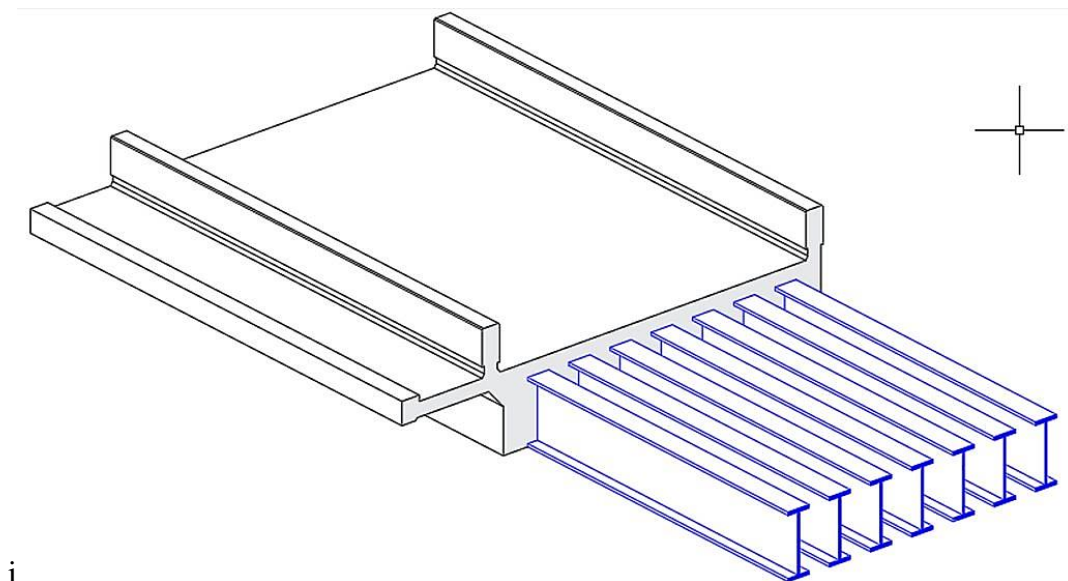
1 – Vedere în spațiu pod cu grinzi înglobate în beton
